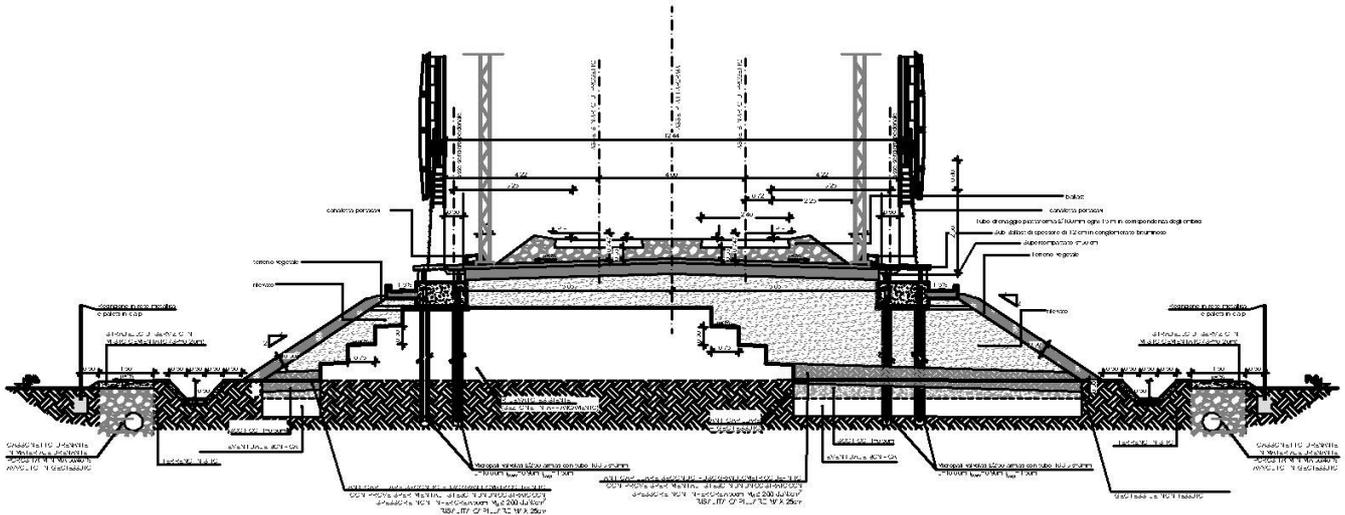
sezione tipo rilevato con barriere antirumore in affiancamento in assenza di esercizio
